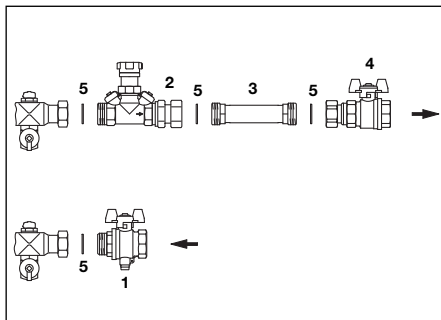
Set di collegamento conta calorie n. 1, versione diritto, fornitura e disposizione dei componenti per collegamento sul lato destro
